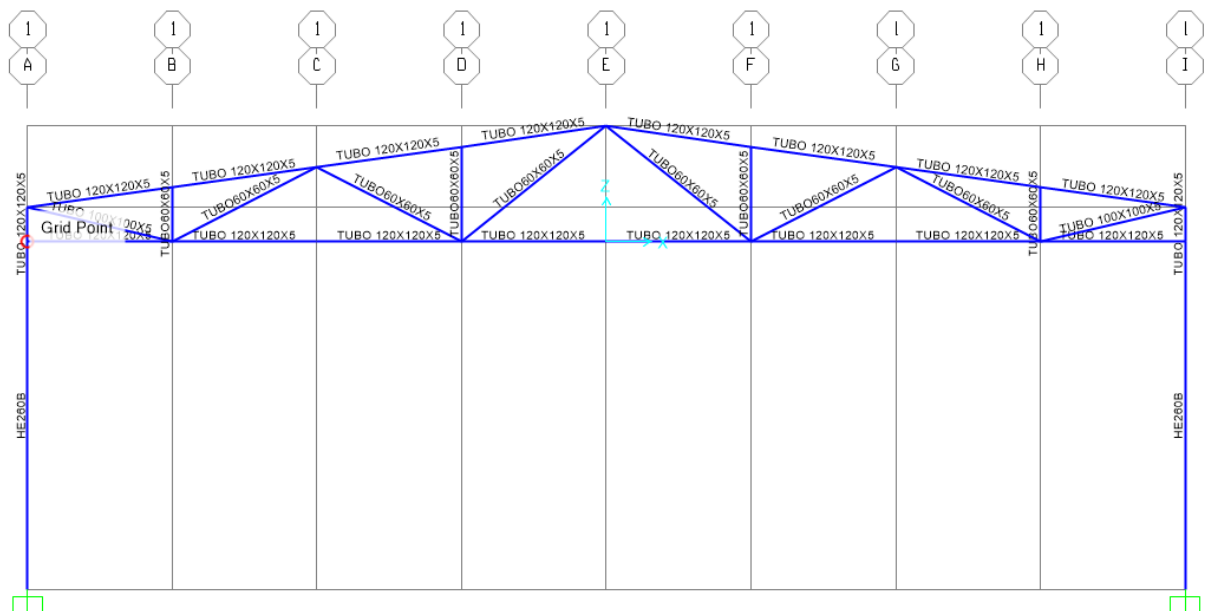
Perfiles estructura principal. Fuente SAP -2000
